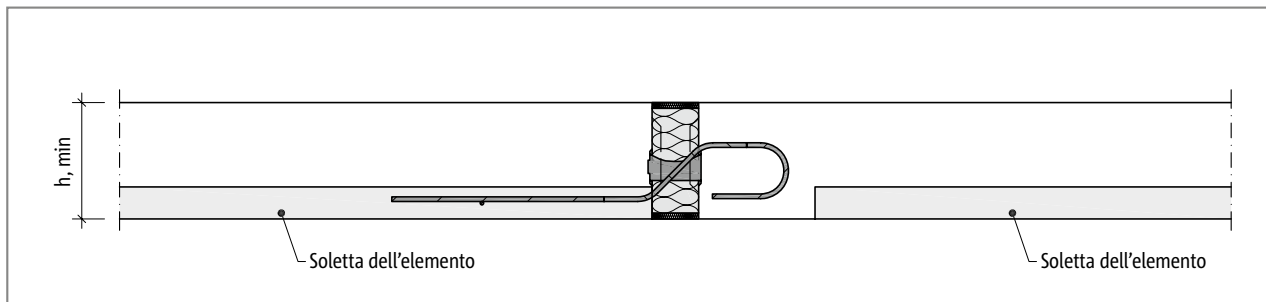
Schöck Isokorb® T tipo QL, QP: solaio prefabbricato con Isokorb® T tipo QL/QP inserito
